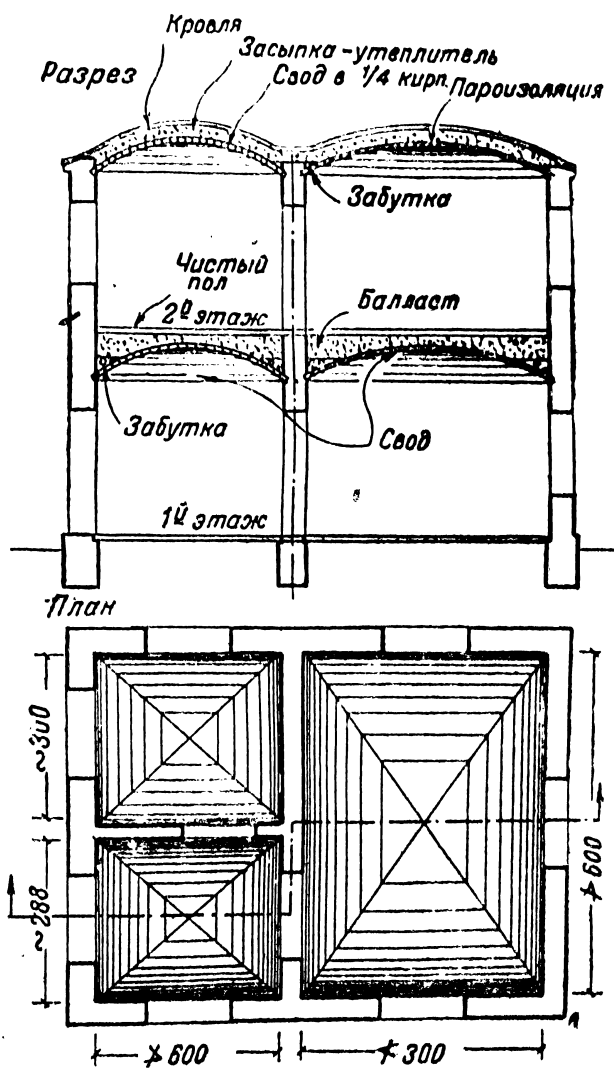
Перекрытие и покрытие из сомкнутых сводов
